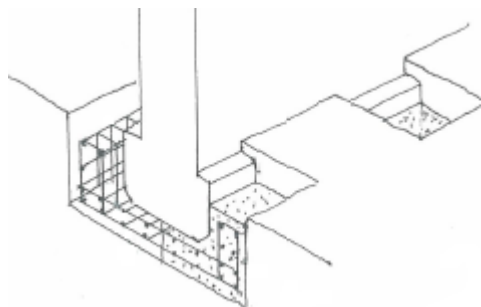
Execução da metade da armadura correspondente ao outro lado da fundação [55]
